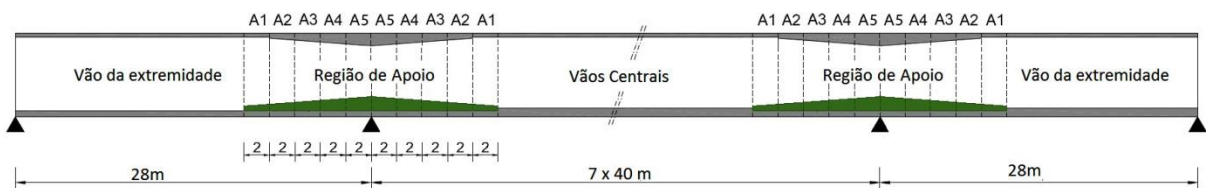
Discretização das vigas metálicas e laje inferior utilizadas na modelação numérica
